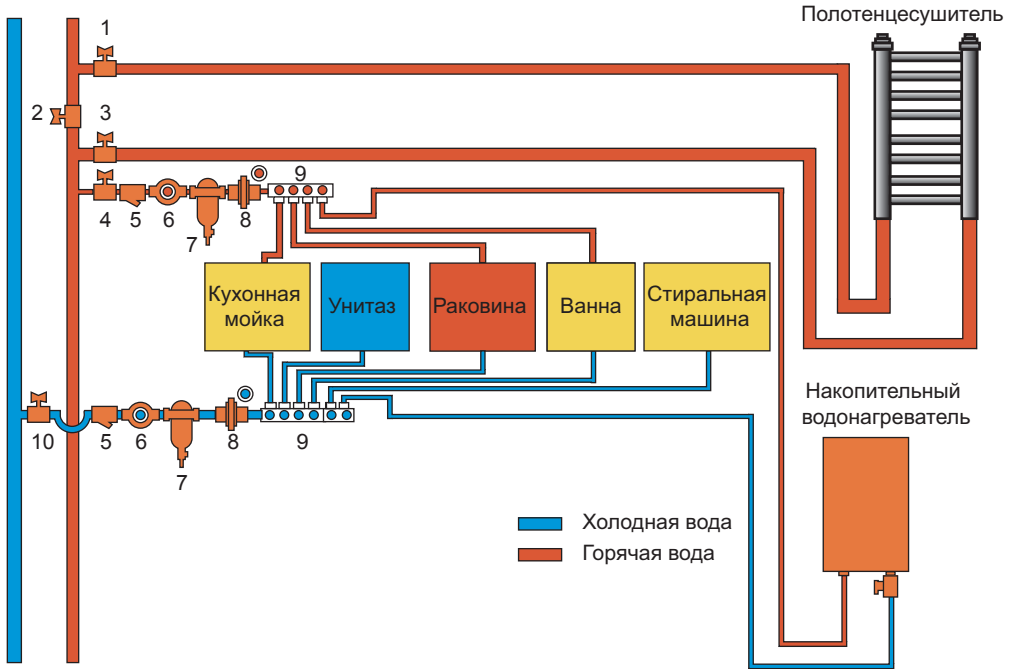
Коллекторная схема разводки водопровода: 1 — верхний шаровой кран на полотенцесушитель; 2 — шаровой кран на перемычке трубы; 3 — нижний шаровой кран на полотенцесушитель; 4 — основной (аварийный) шаровой кран на горячую воду; 5 — фильтр грубой очистки; 6 — счетчик; 7 — фильтр тонкой очистки с сеткой 100 мкм; 8 — редуктор давления; 9 — коллектор; 10 — основной (аварийный) шаровой кран на холодную воду
